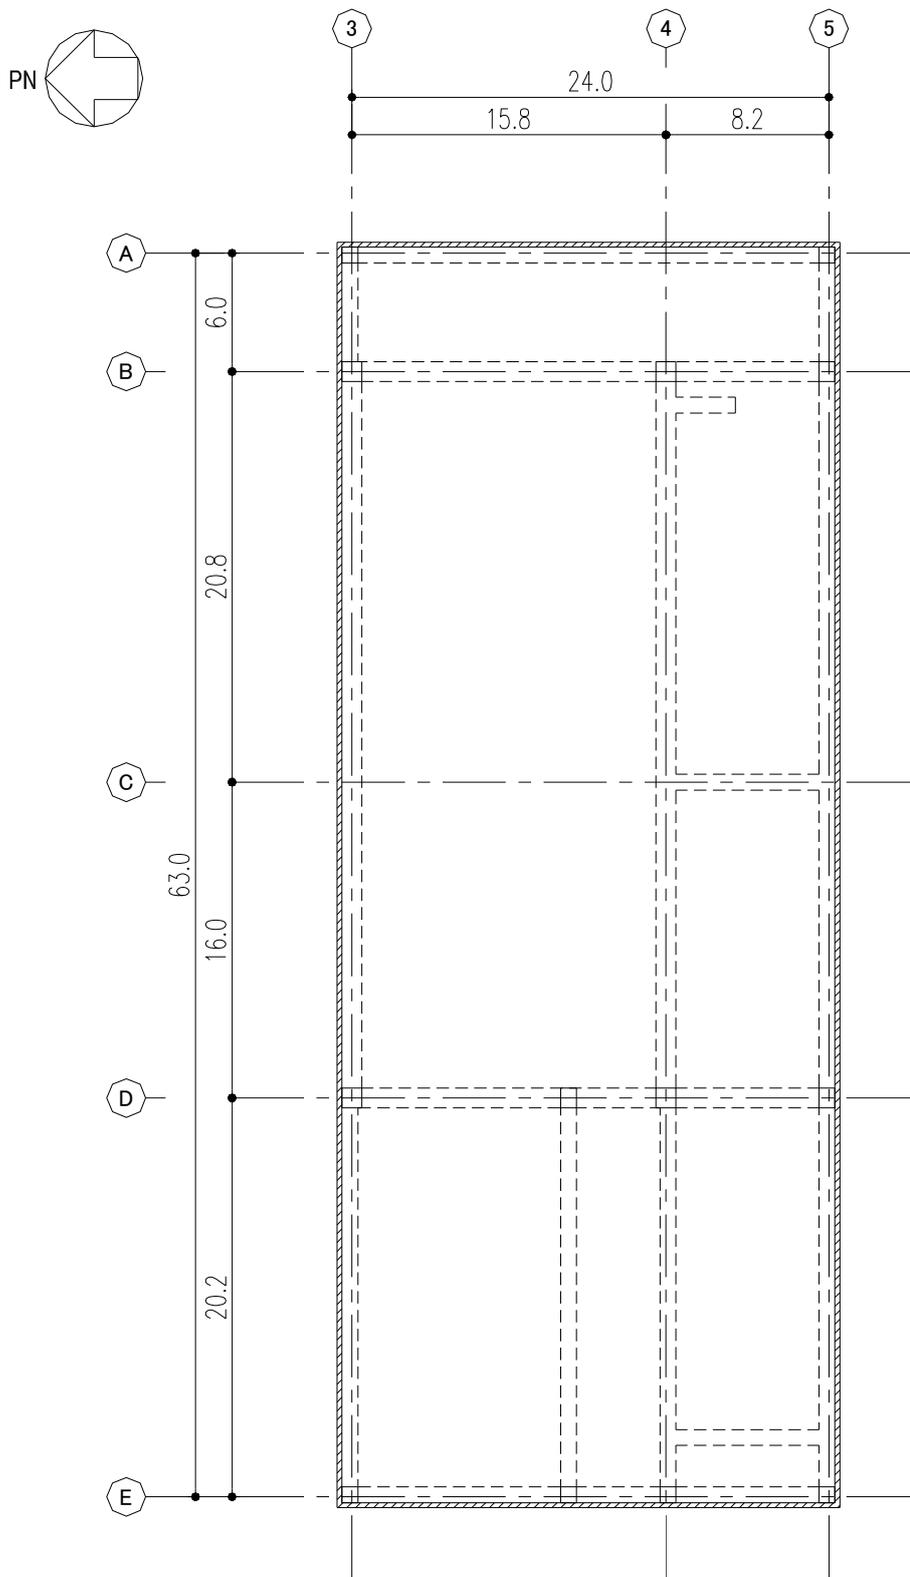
スラッジ棟 屋根平面図 (設計 G.L. +11.1) (単位 : m)
